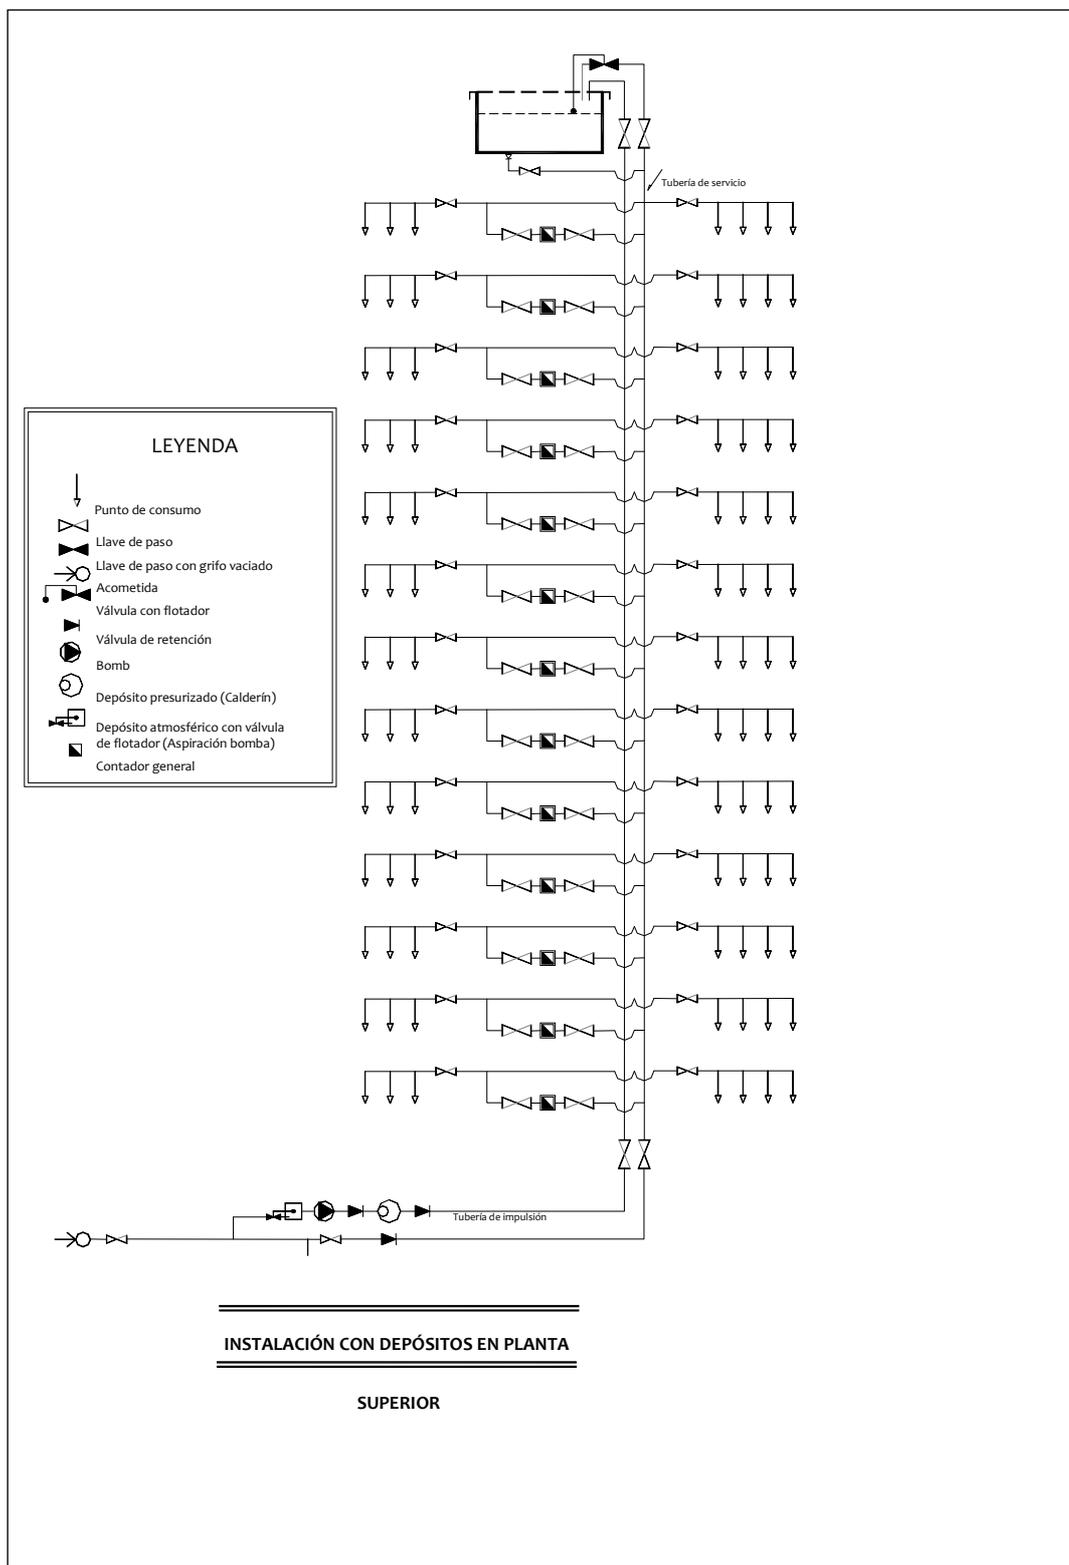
Suministro con depósito superior y contador divisionario por planta
